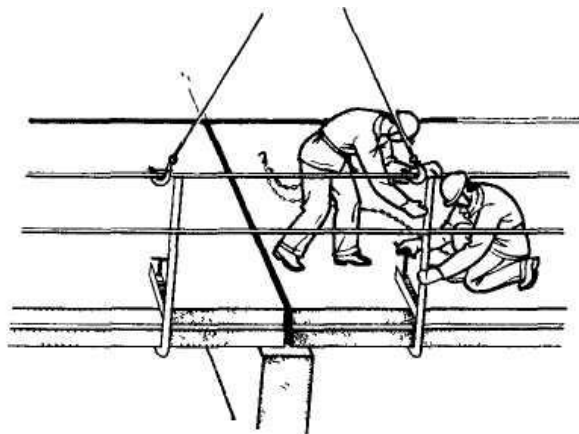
Укладка и анкеровка плиты перекрытия
